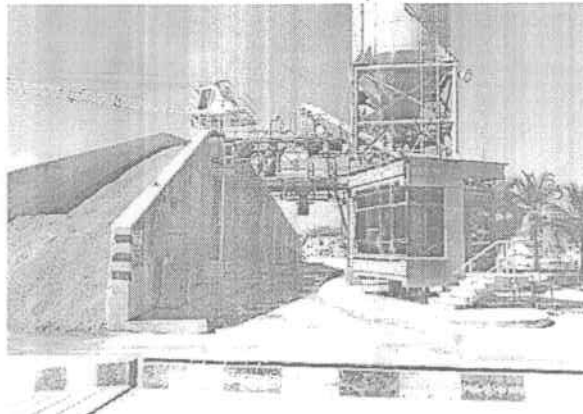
Punto de dosificación de concreto con entrada y salida de mixers.
